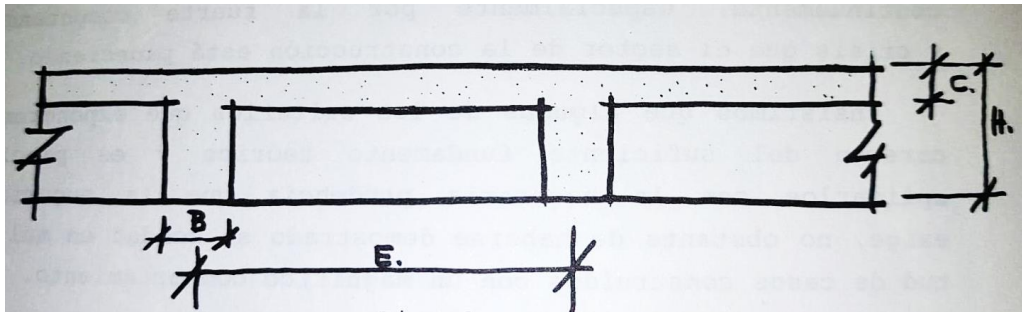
Esquema de los parámetros básicos de un forjado reticular.
